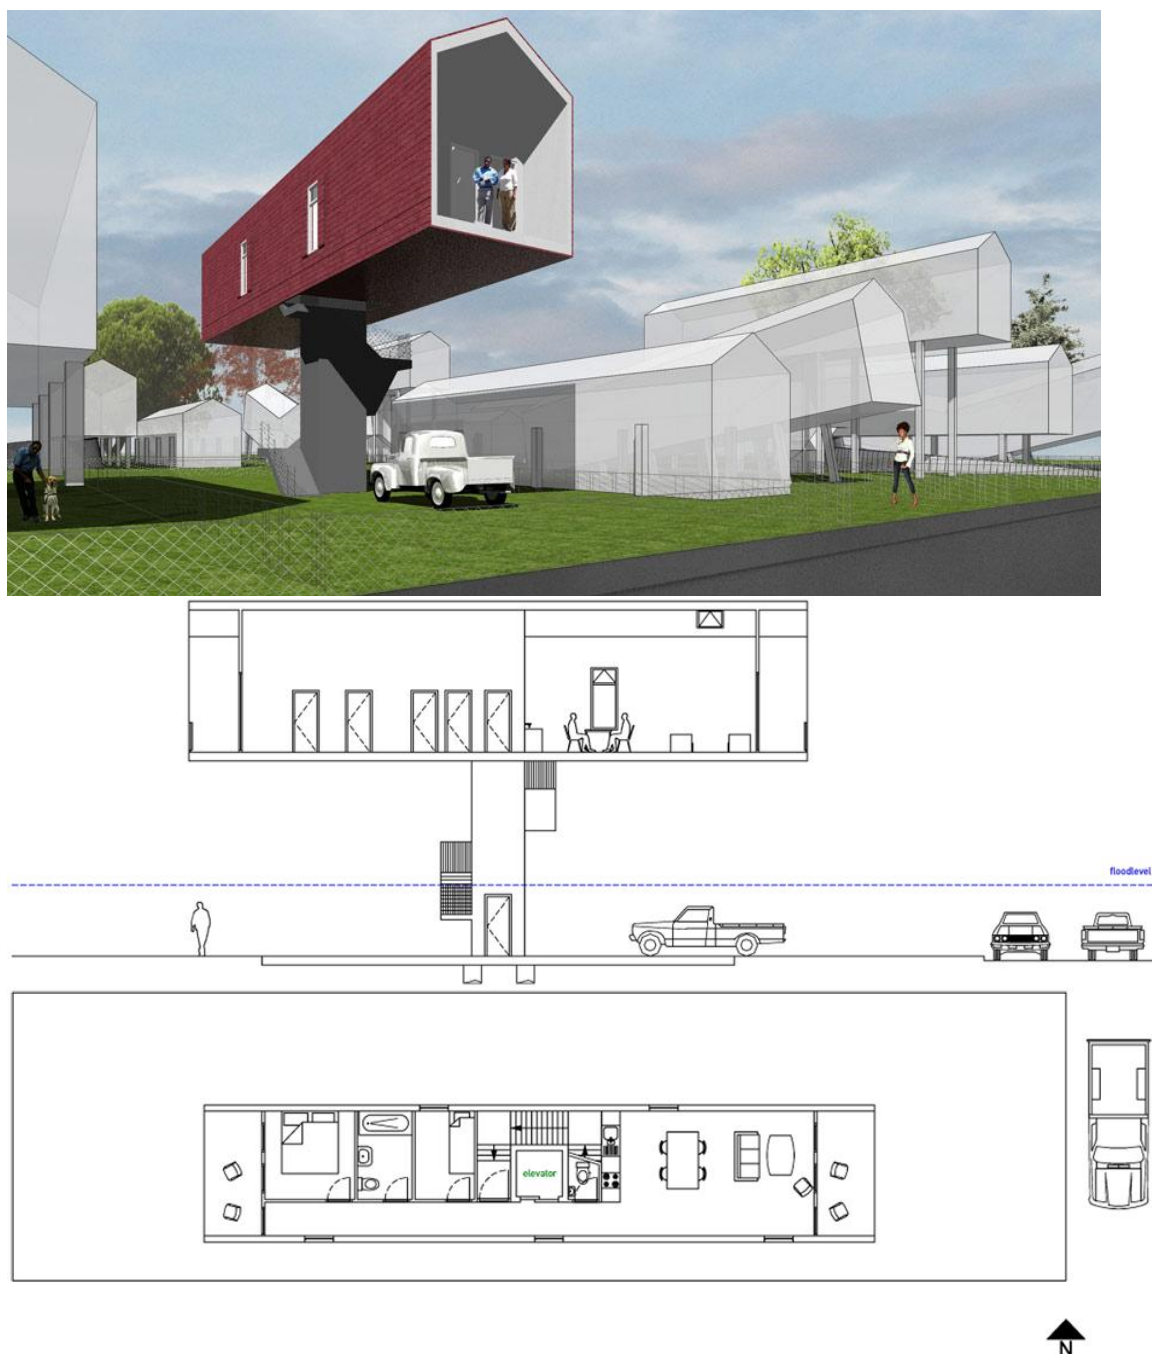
Perspectiva, corte e planta da *House on a Lift
